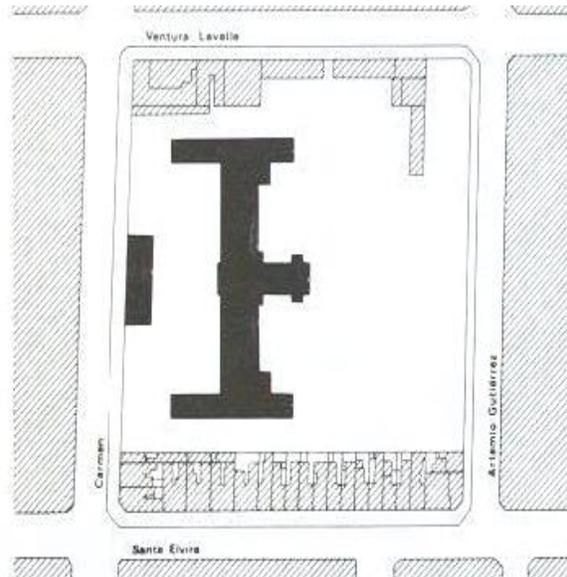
Plano emplazamiento. Fuente. Revista CA N 55. 1989.
